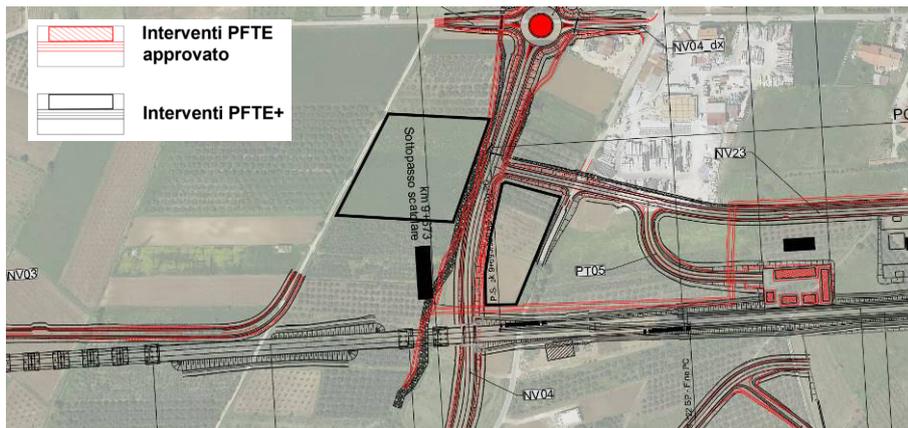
Modifiche all'area di cantiere AS.12. Sovrapposto cantieri con il sistema dei vincoli (in rosso il PFTE e in nero il PFTE+)
